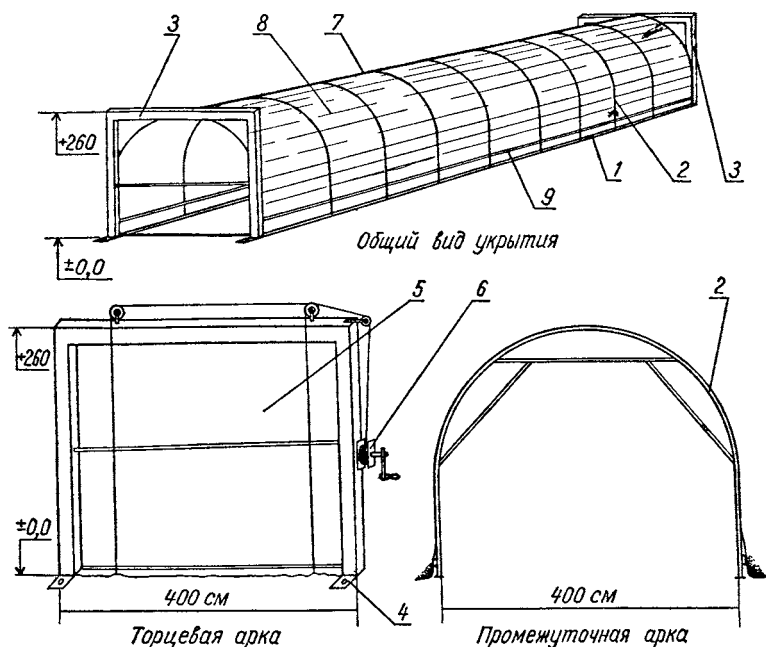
Конструкция передвижного укрытия с металлическим каркасом:
